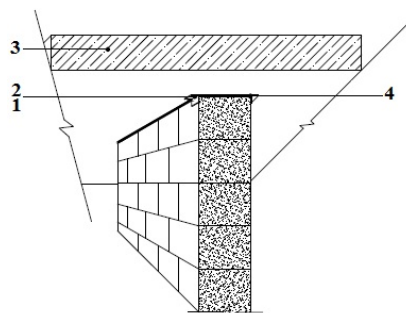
Примыкание внутренней стены из газобетонных блоков к железобетонному перекрытию (каркасно-монолитное строительство): 1 — металлический уголок (45×45×5); 2 — крепеж (пневмодюбель); 3 — плита перекрытия; 4 — заполнение монтажной пеной
